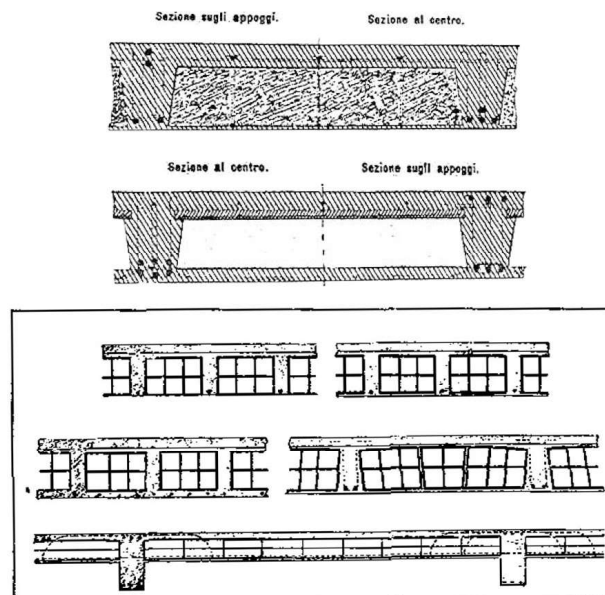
Plancher avec béton armé (en haut) et plancher en poutrelles et entretous d'après le catalogue de l'entreprise Ghilardi et Conigliaro
